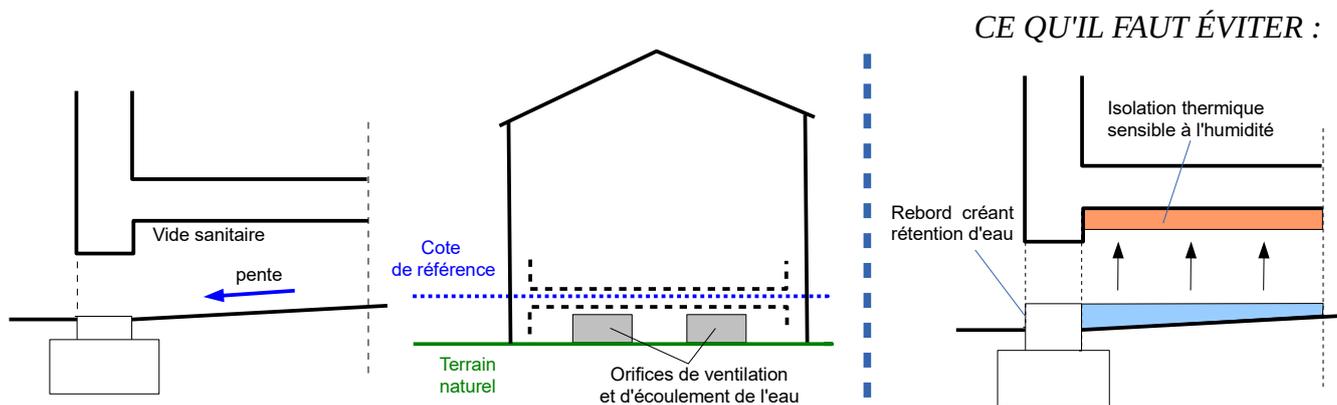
Schéma de principe d'une construction sur vide sanitaire
